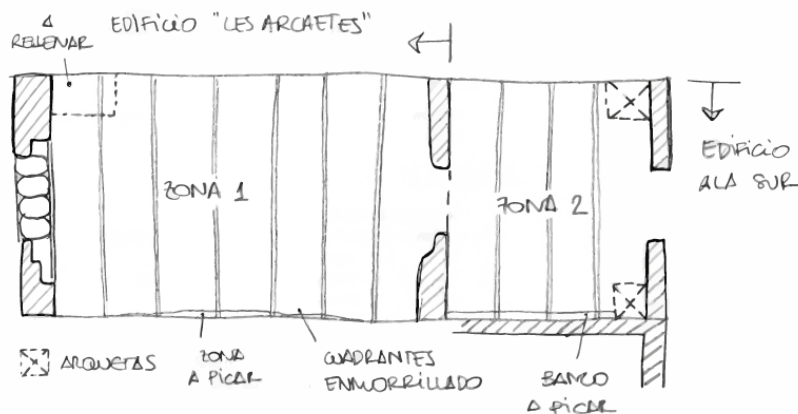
Croquis de la planta baja Ala Sur- “les Arcaetes”. Sección longitudinal en planta.
